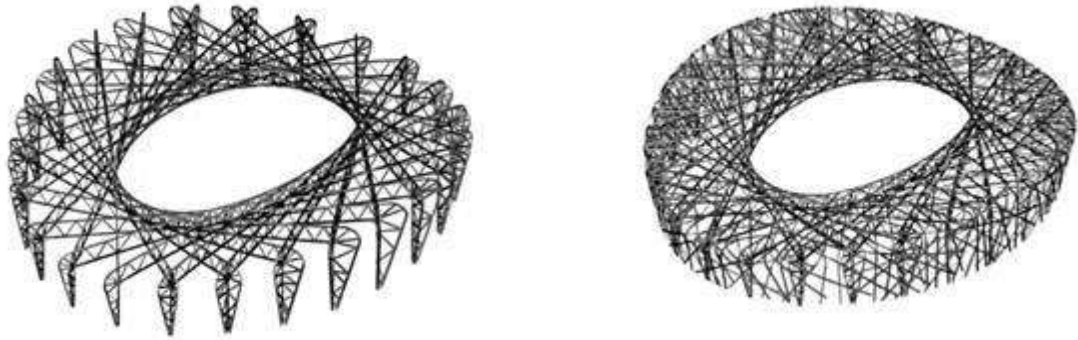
Двадцать четыре фермы — опоры здания переплетены «стяжками»
